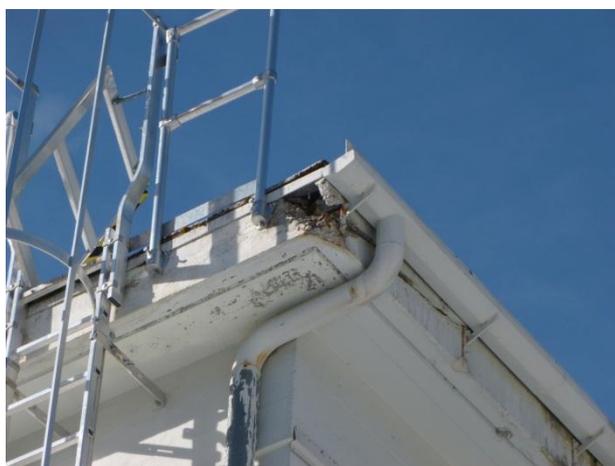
Vue du débord béton dégradé – Détail cheneau - façade est
